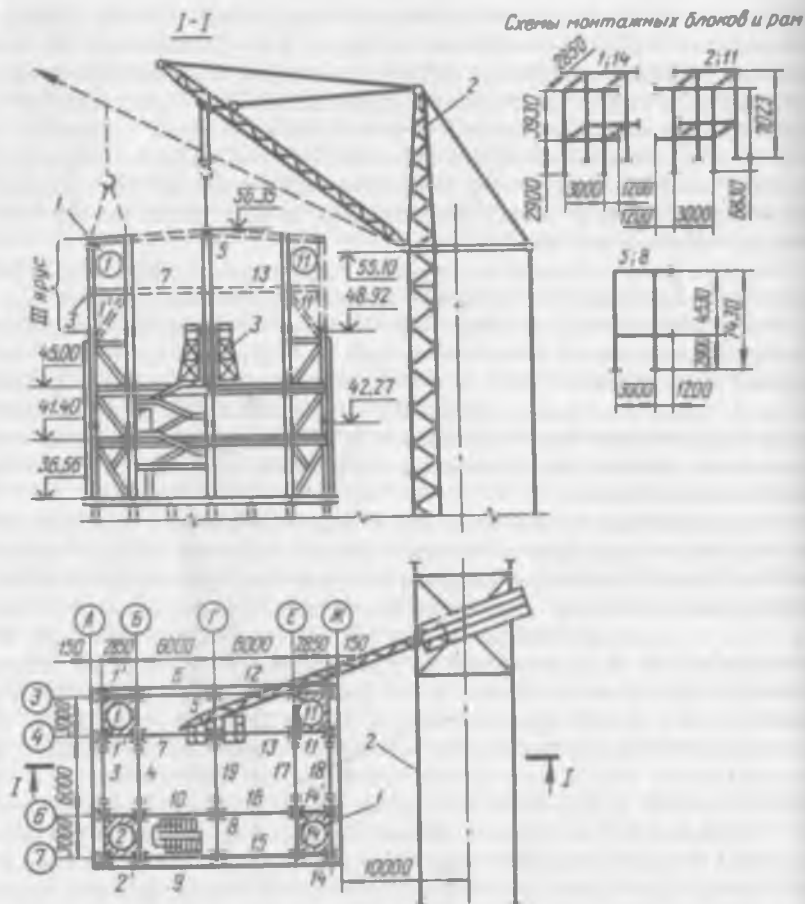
Схема монтажа III яруса надстройки рабочего здания РЗС-4х175 башенным краном КБ-503:
